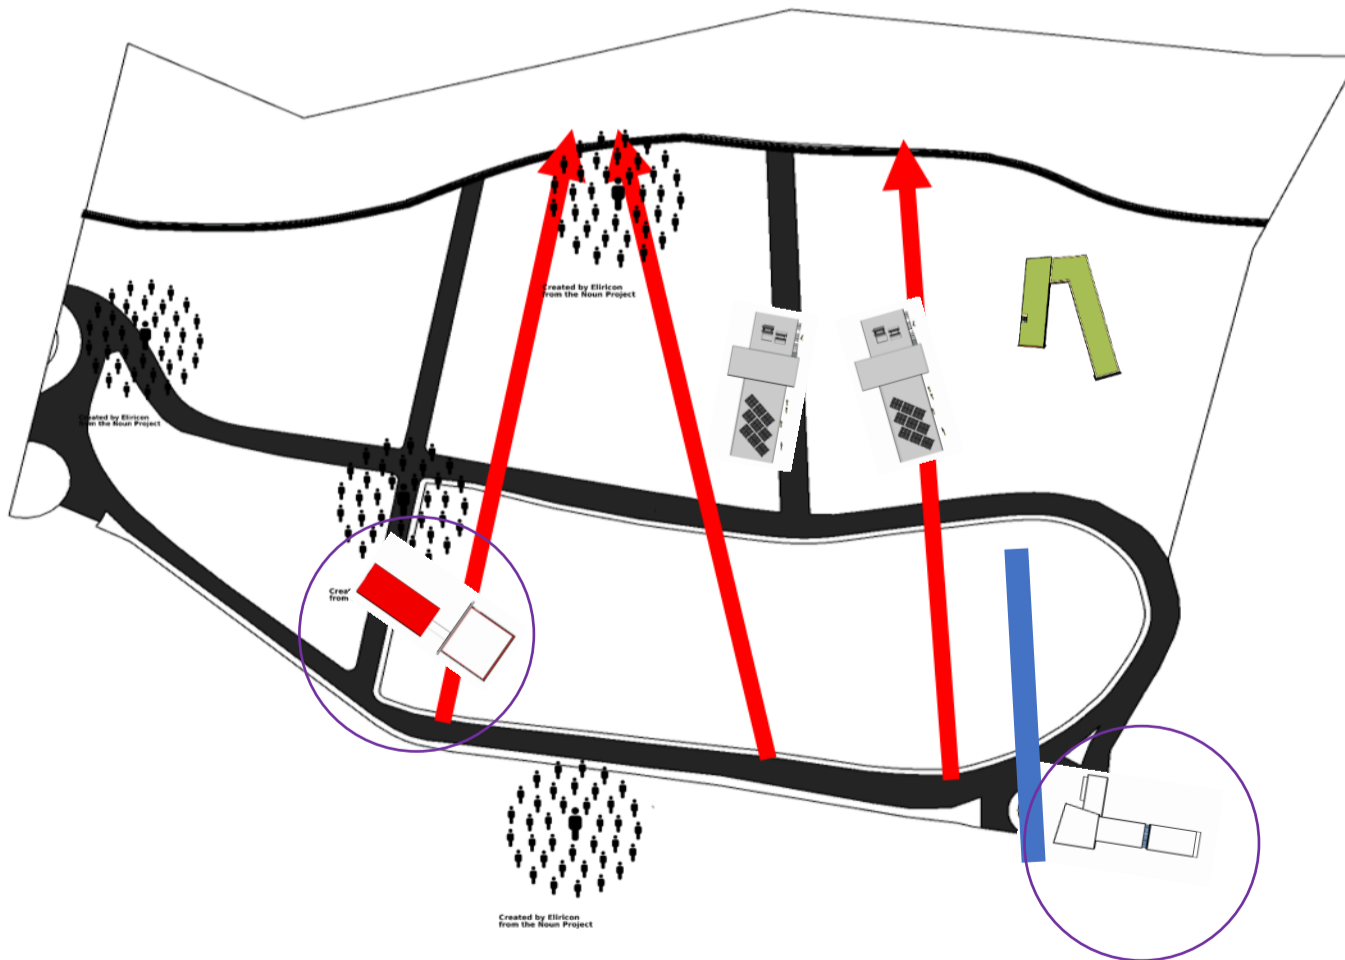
Prolongement d'une ancienne route et reconstruction du commissariat et bâtiment des pompiers
